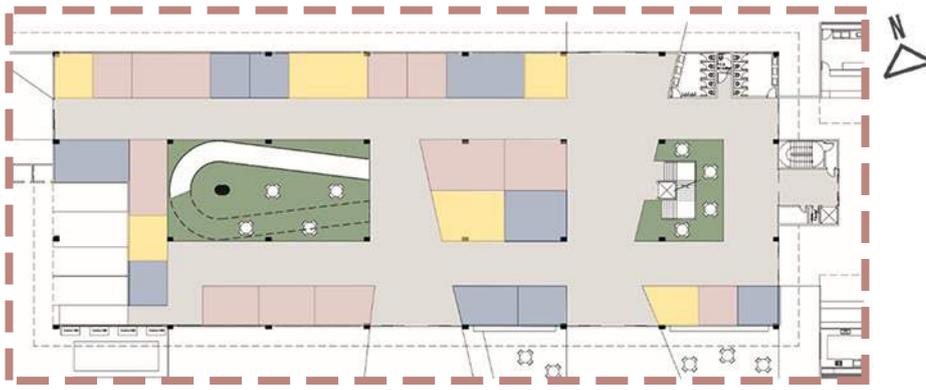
Planta do pavimento térreo com disposição dos usos dos quiosques.
